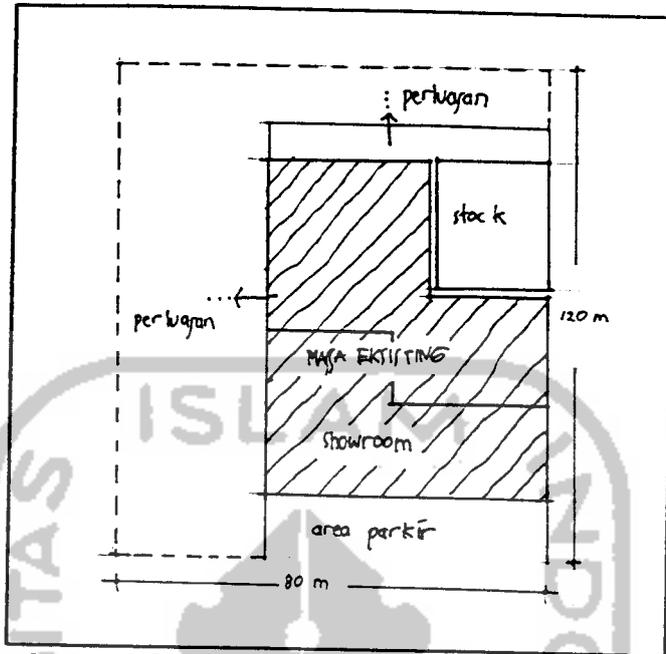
Denah Lokasi Showroom Toyota di Jl. Magelang
